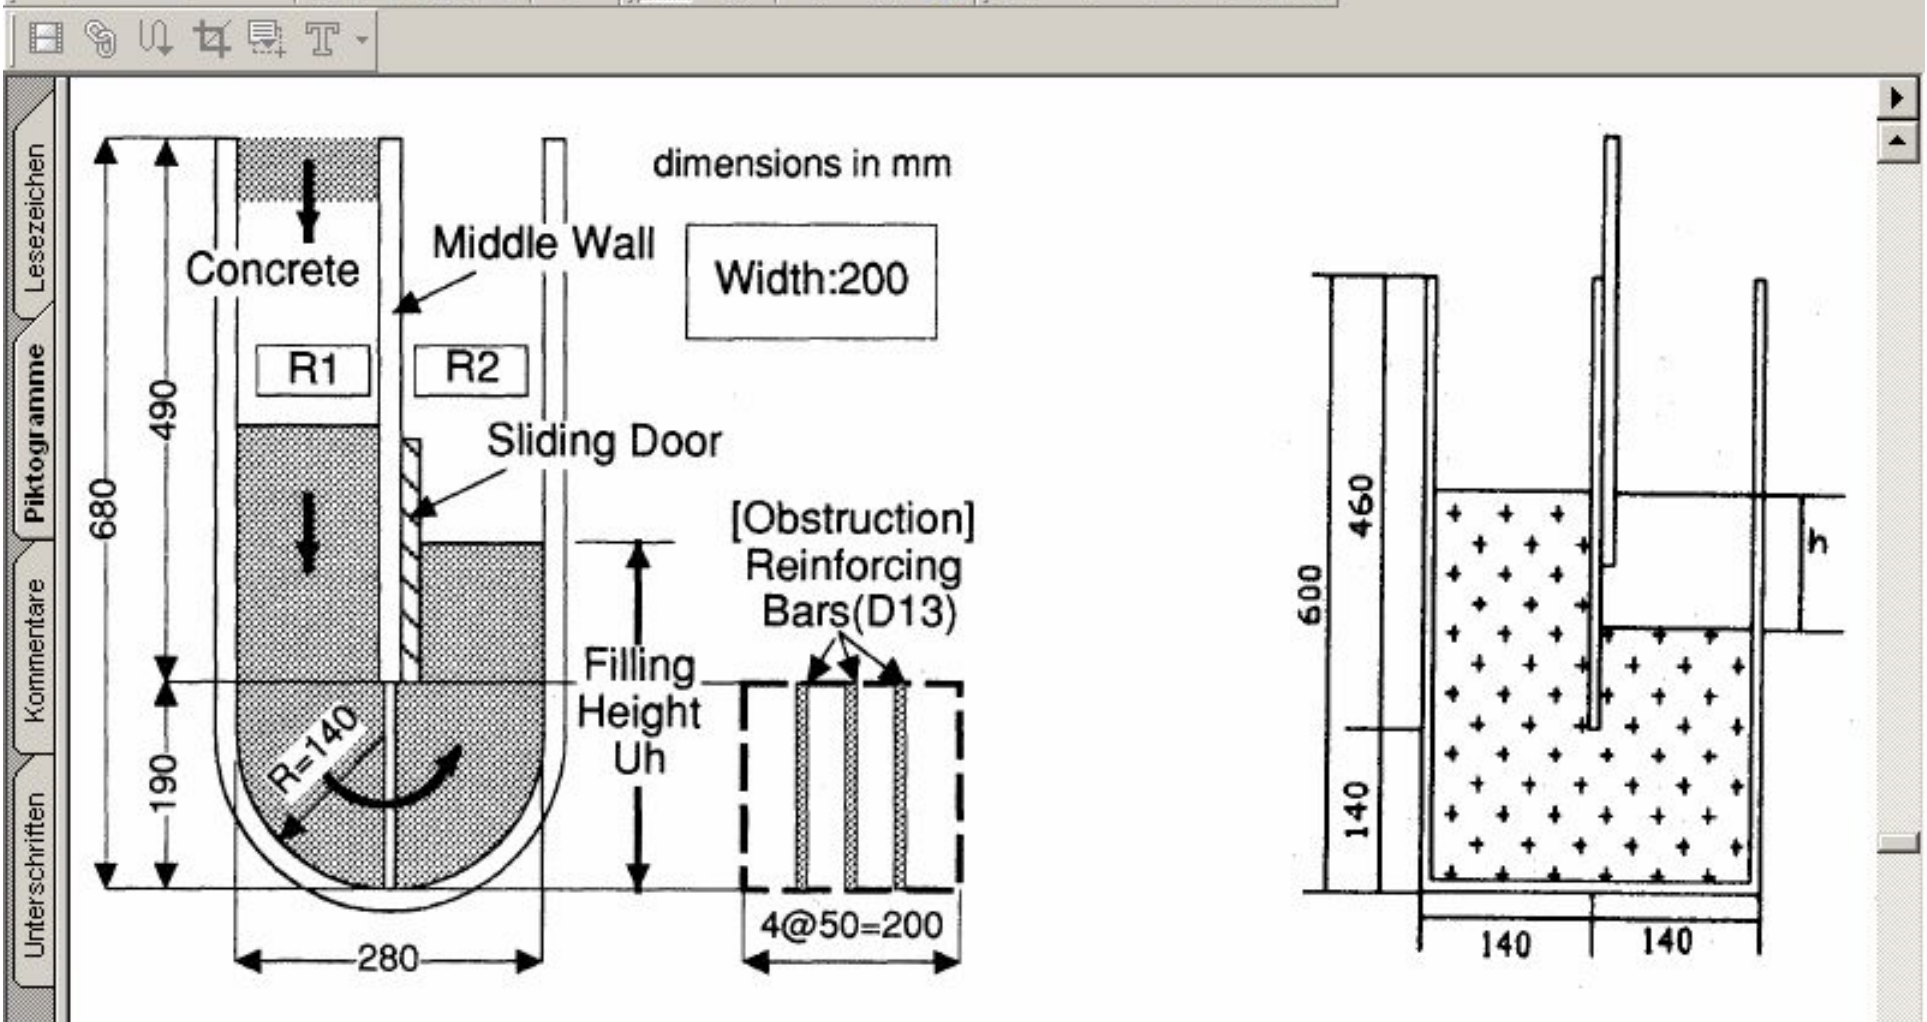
U-Rohr (links) und U-förmiger Box Test (rechts) mit Bewehrungshinderniss
